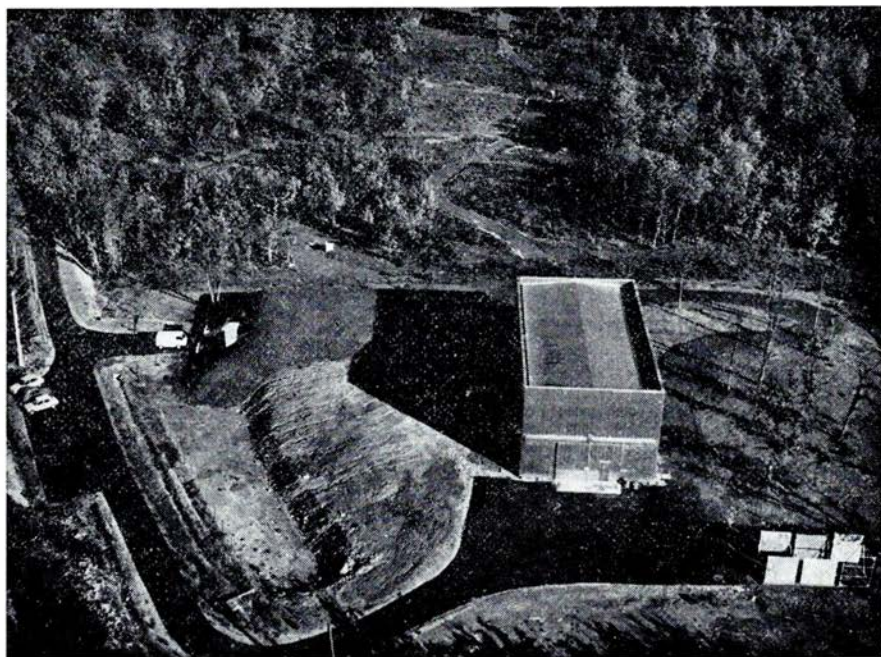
STIRCA - Vue d'ensemble des bâtiments
